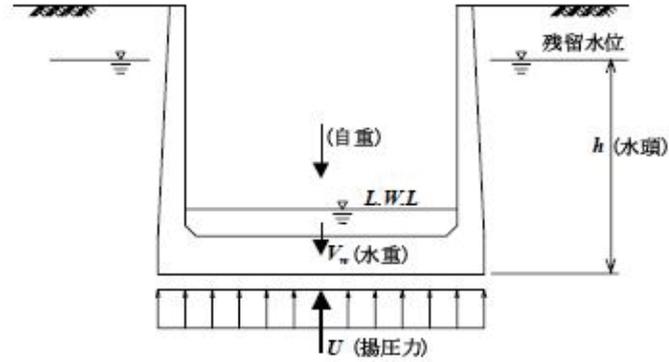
翼壁の浮上りに対する検討 (図 4.1.7-6 参照)
